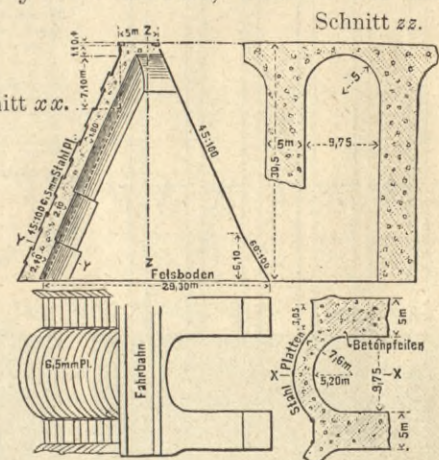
Beton-Staumauer mit Stahlplatten, 18m hoch, in Ogden (Utah).
